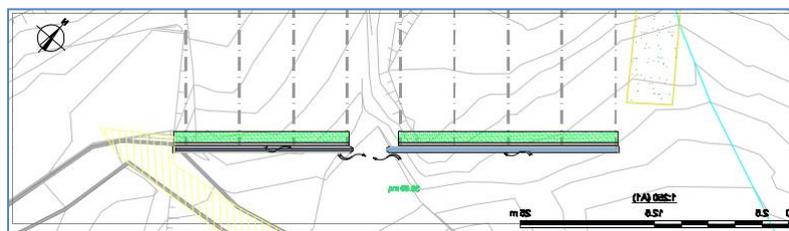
Inerbimento area lavorazione "dreni sub-orizzontali"
